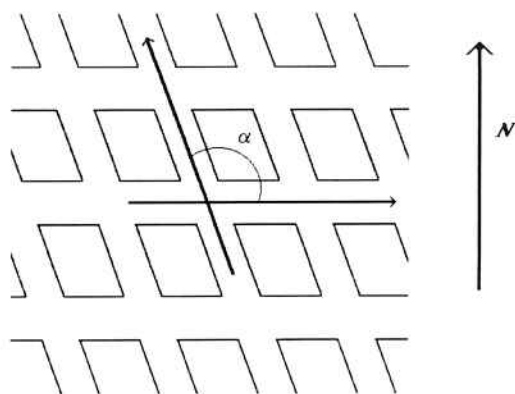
Conjunto de galerias utilizadas no método de lavra por câmaras e pilares
